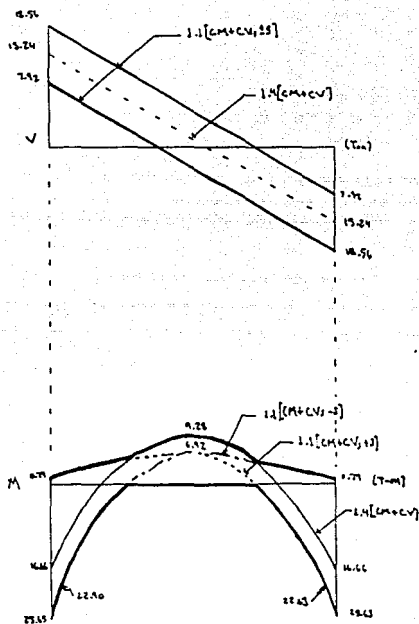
Envolvente de elementos mecánicos para la viga 55-56, marco 2, con la estructura reforzada.
